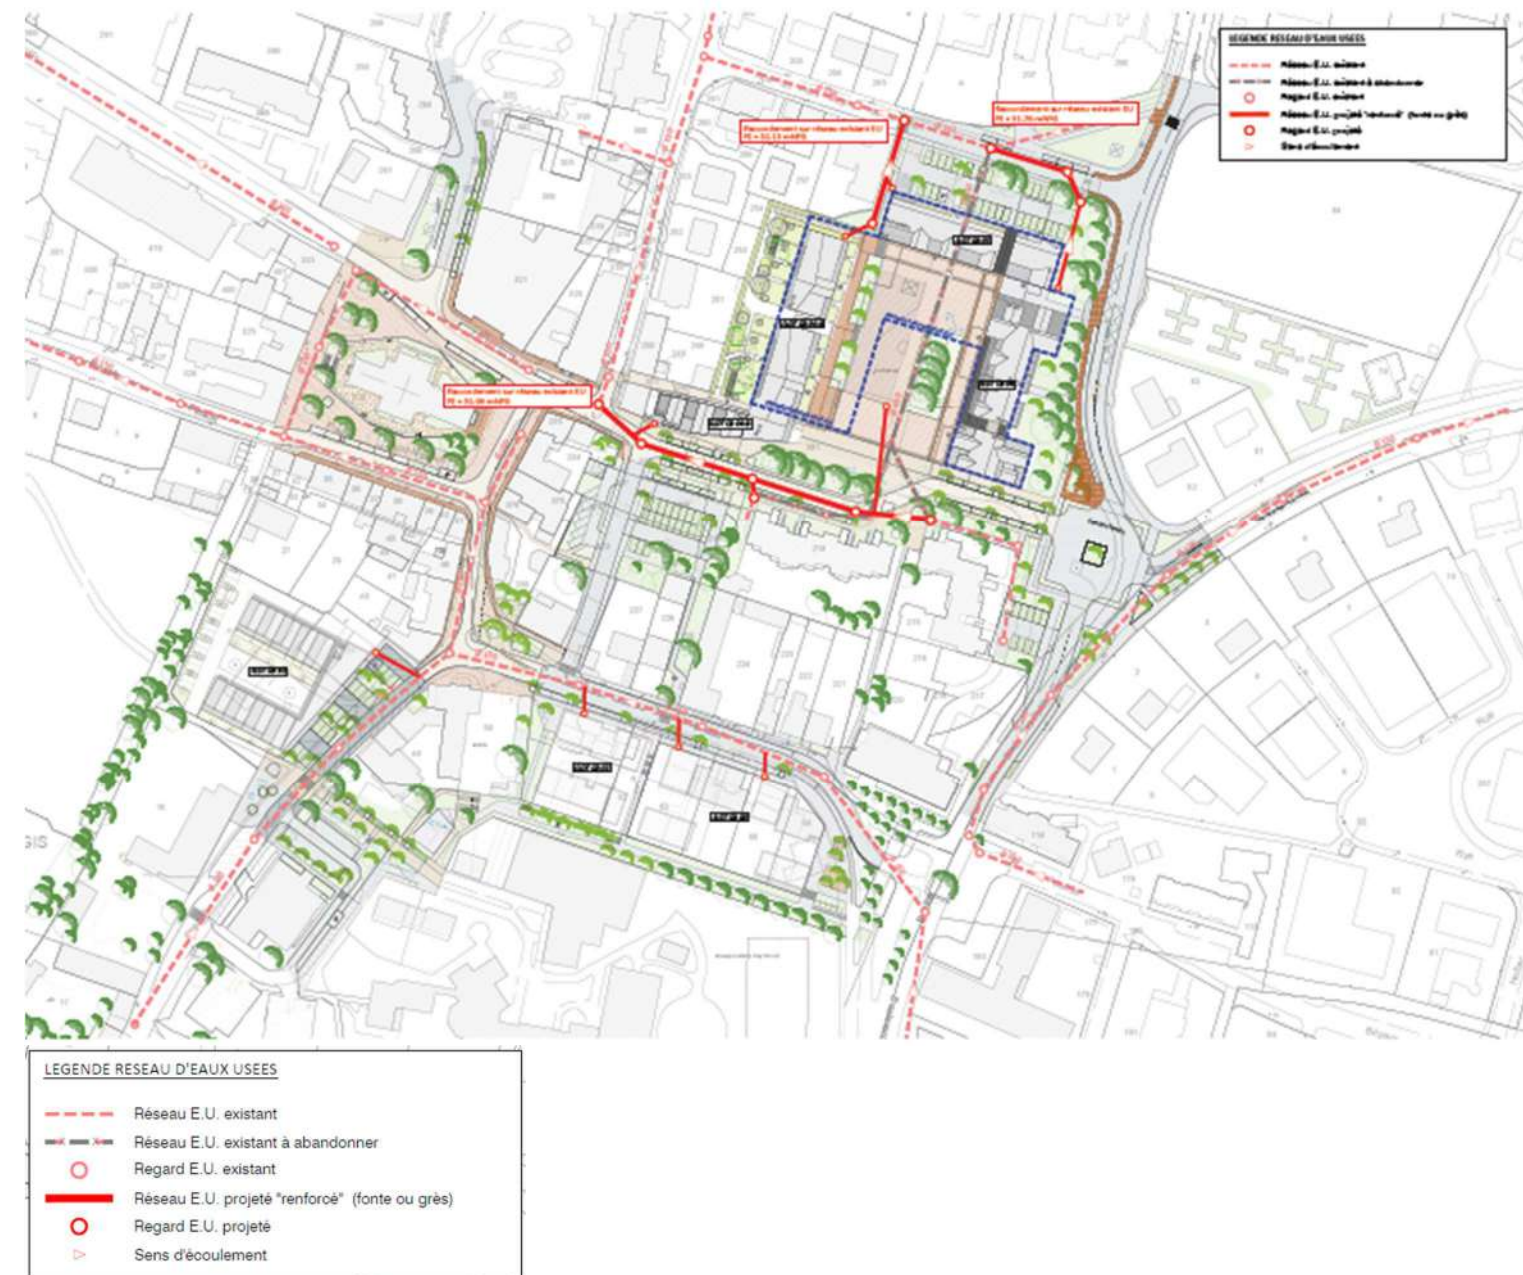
plan du réseau d'eaux usées du secteur Centre-bourg - Stade AVP
